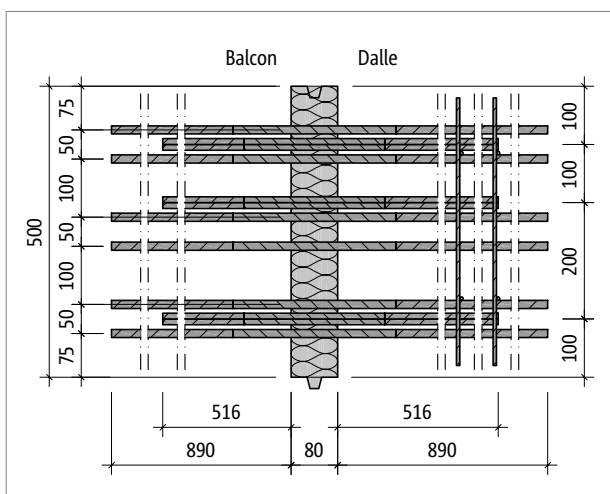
Schöck Isokorb® T type D-MM6-VV3 : plan de base
